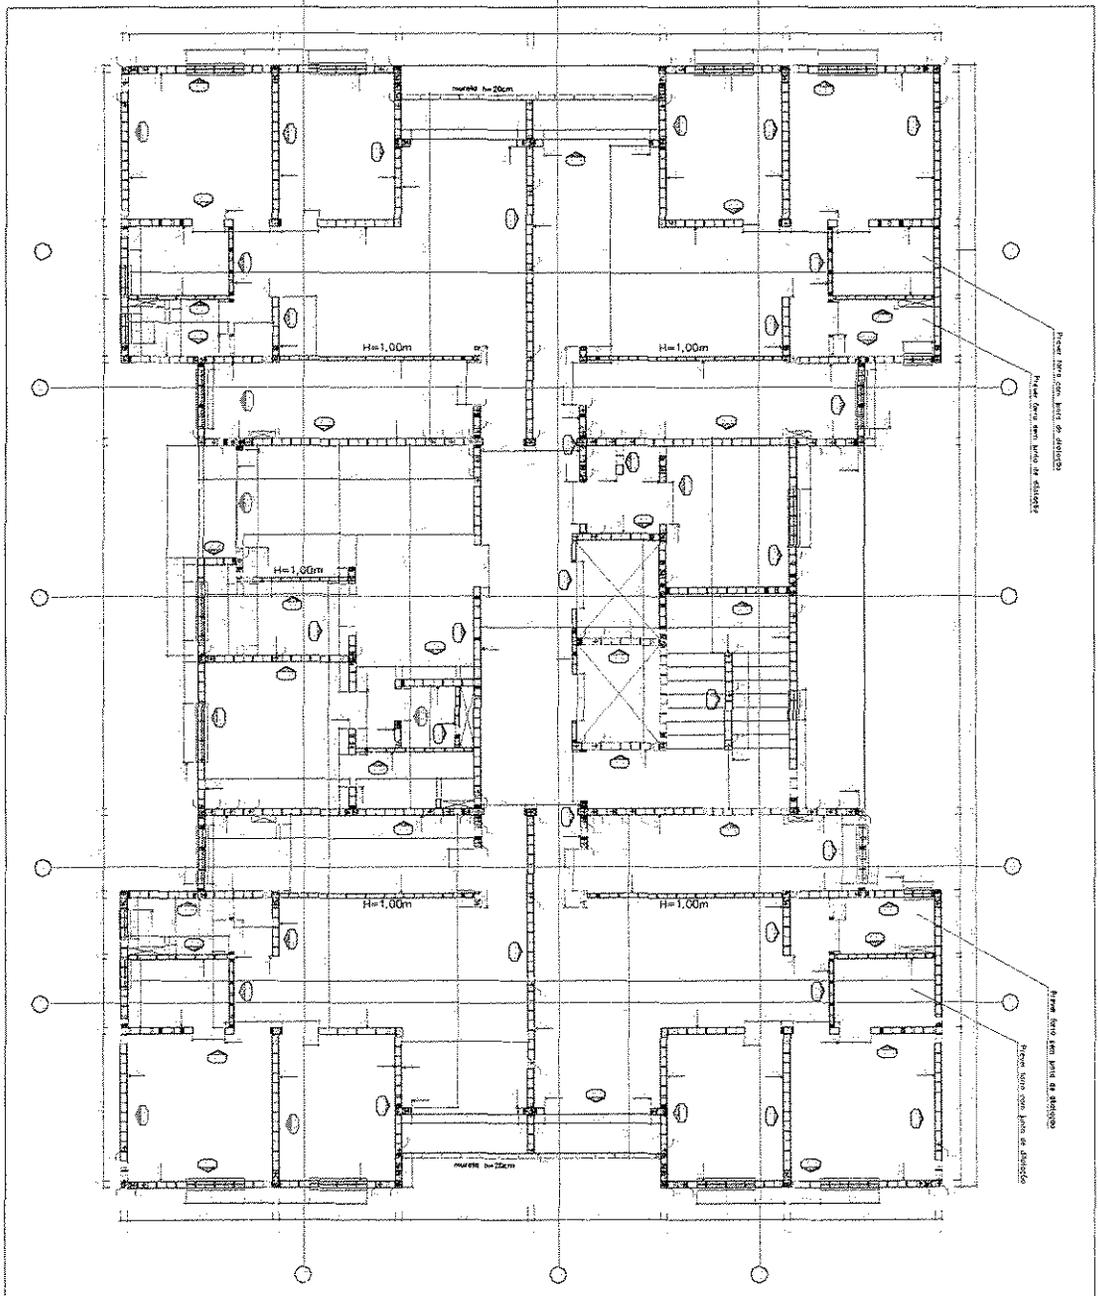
Planta da Modulação do Pavimento Tipo
